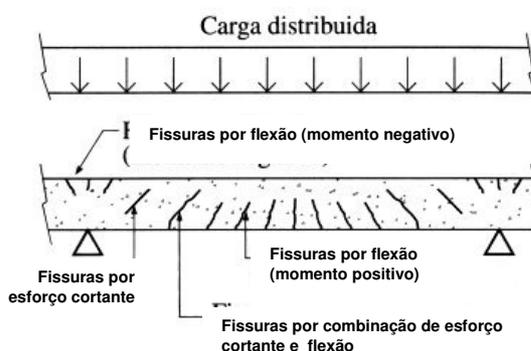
Representação esquemática das patologias observadas em vigas de concreto armado com fissuração devido ao esforço cortante e flexão (HELENE, 2003).
